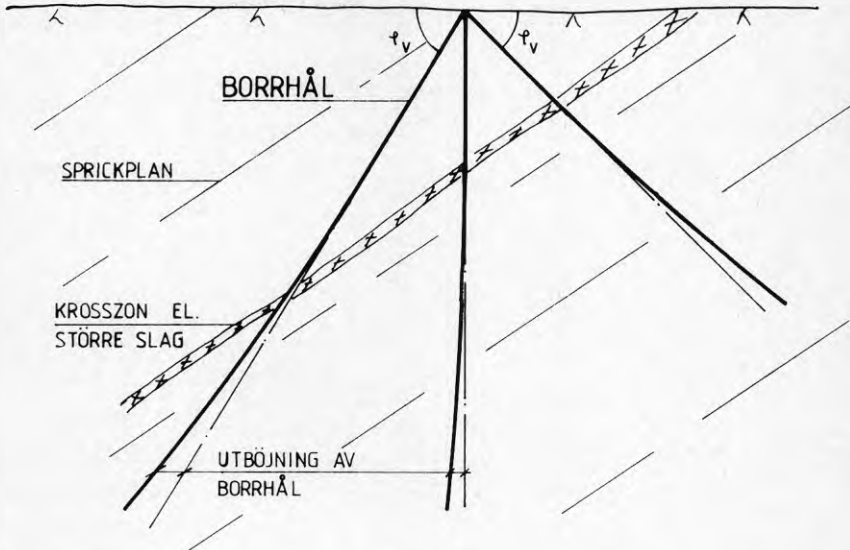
Borrhålsavvikelse i lagrets botten, plan
